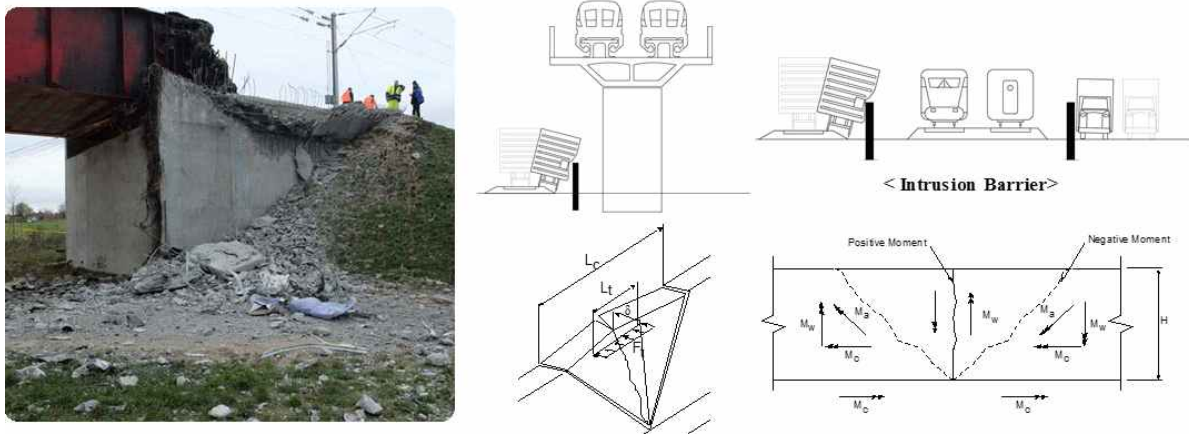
Intrusion Barrier Structure(AASHTO LRFD Bridge Design Specifications)
